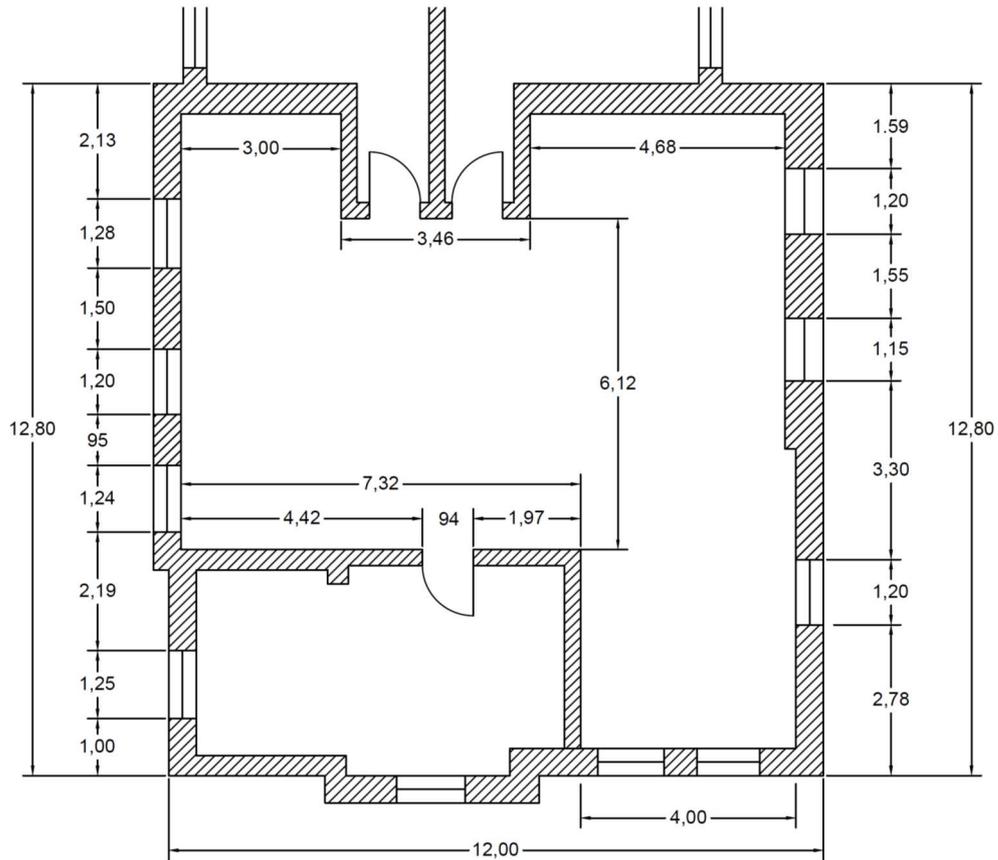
Grundriss des Büroraums mit erhobenen Raummaßen. Quelle: Eigene Darstellung.
